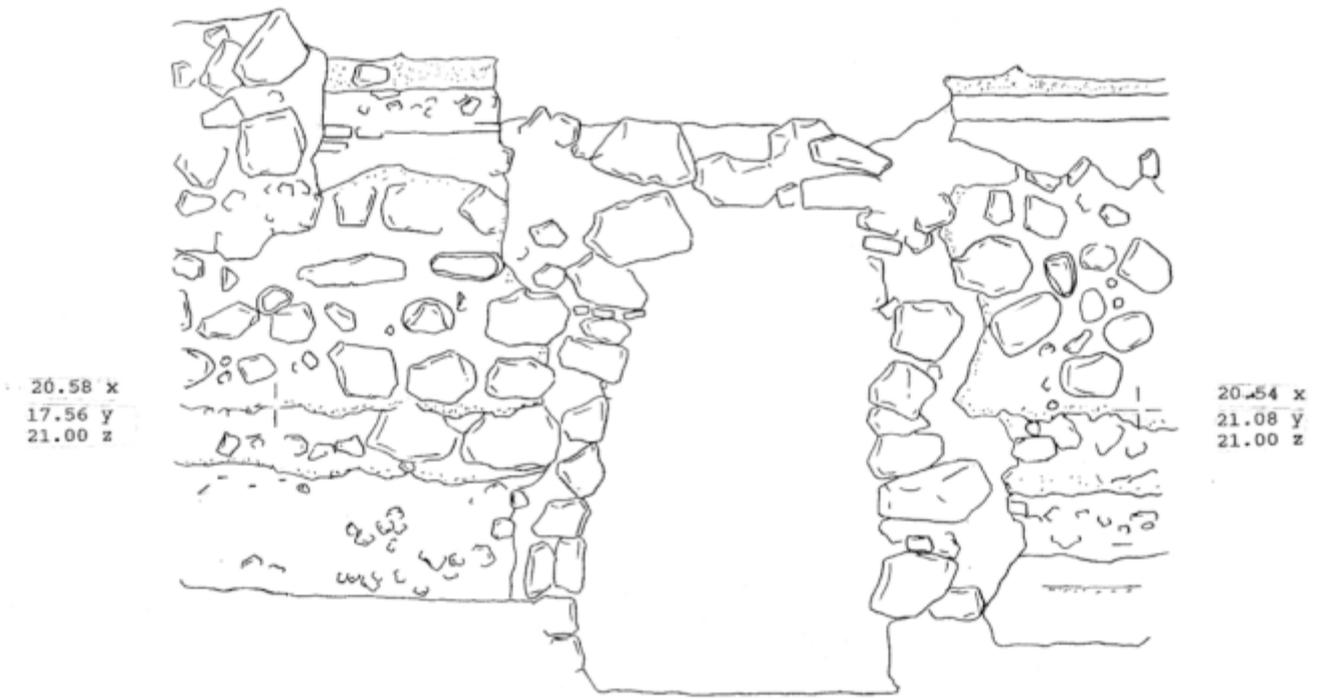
Alzado de la cara interna de la muralla. Área 4. Escala 1:40.
